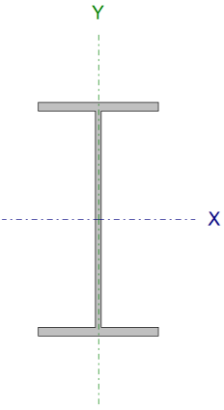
Vista en perfil de la viga diagonal de arriostramiento nivel 1 (C10-C13)
